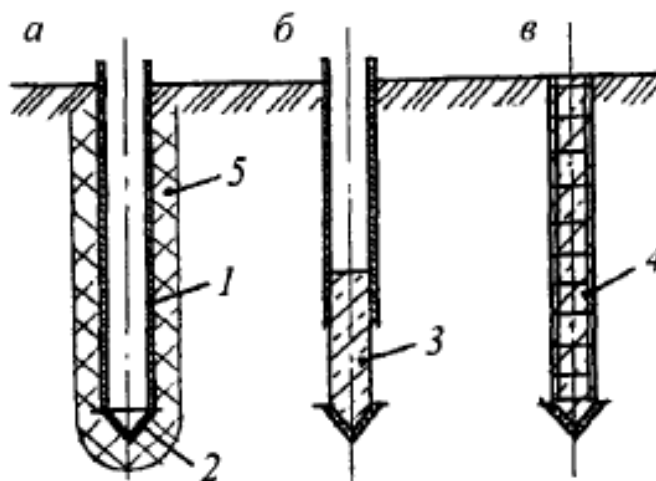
Последовательность изготовления набивной сваи: а - погружение инвентарной трубы с закрытым нижним концом; б - укладка бетона в трубу с одновременным ее подъемом; в - установка металлического каркаса; 1 - инвентарная труба; 2 - теряемый башмак; 3 - бетон; 4 - каркас; 5 - уплотненный грунт
